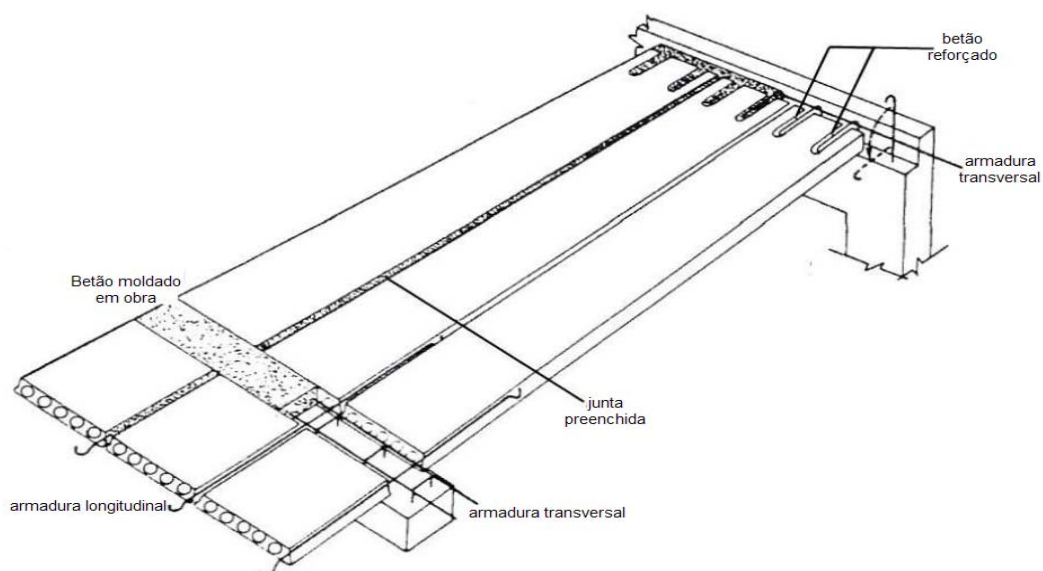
Ligação Laje – Laje e Laje – Viga, com pranchas vazadas (extraída de [10])
